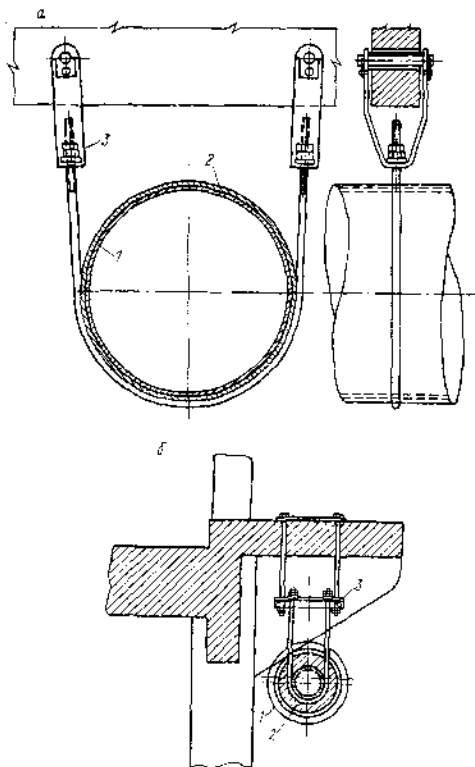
Подвеска газопровода под железобетонным мостом.
